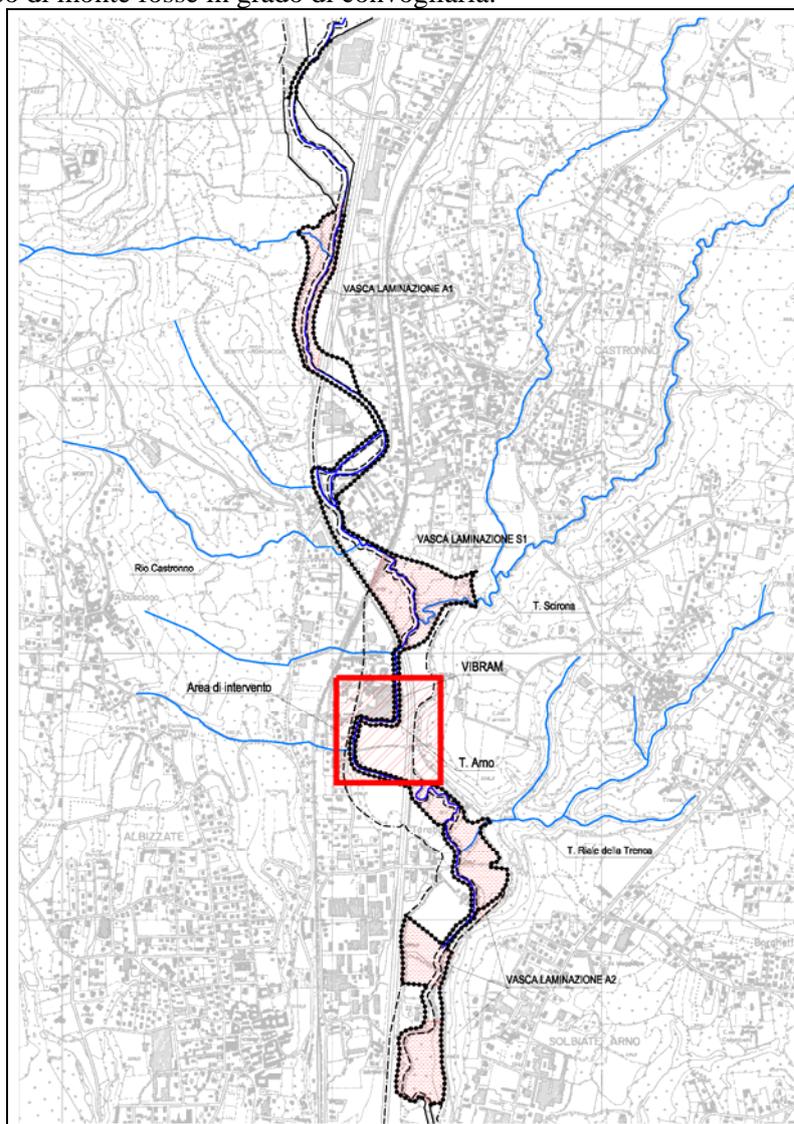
Planimetria con ubicazione delle vasche di laminazione previste nello studio di piano rispetto allo stabilimento della Vibram S.p.A.
